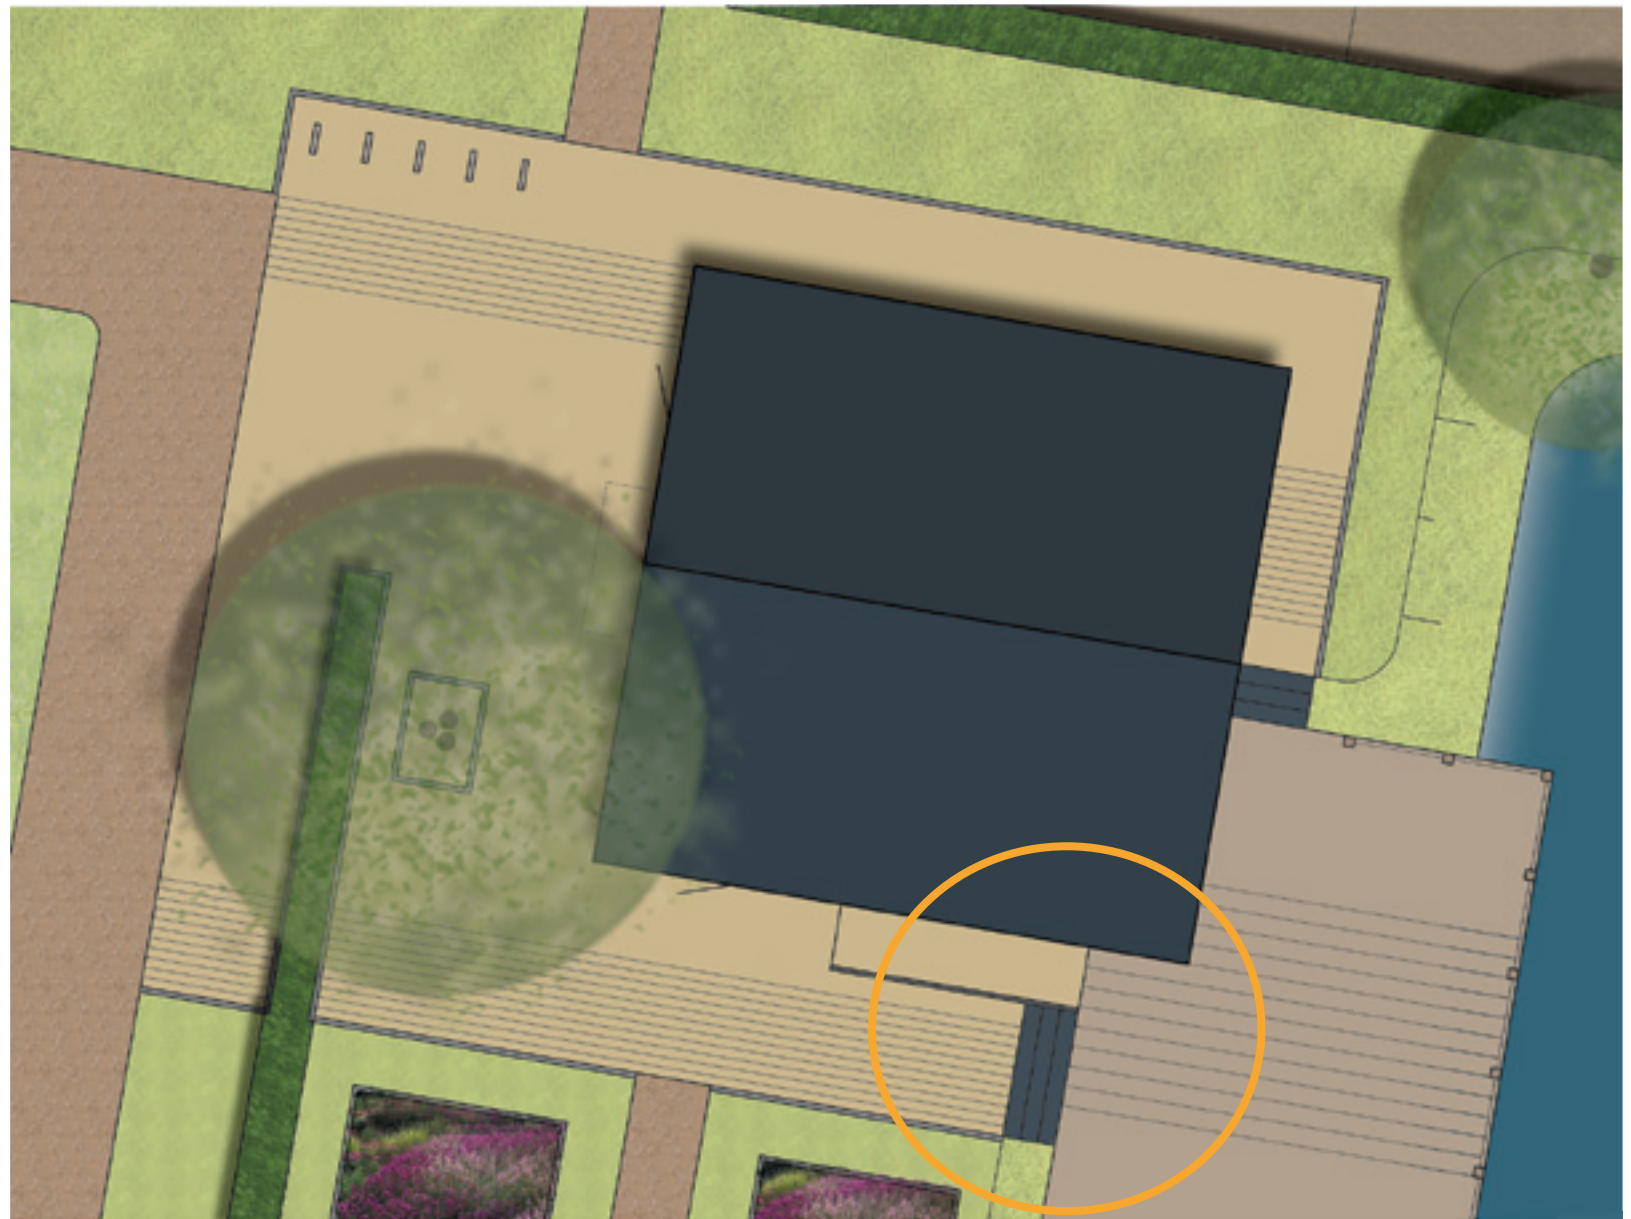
Detailuitwerking van het centrale plein en de aanliggende vlonder rond het gebouw. Origineel schaal 1:100 is bijgevoegd in de bijlage van dit rapport.
